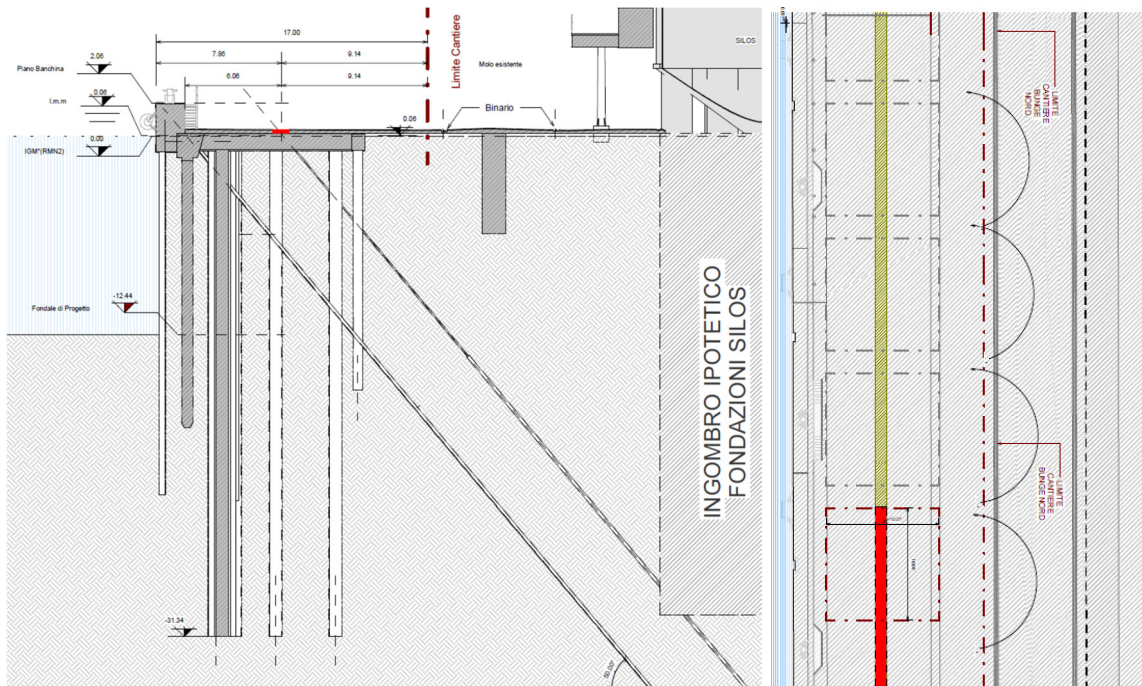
Banchina Bunge Nord – Fase 3 – Sezione e planimetria
